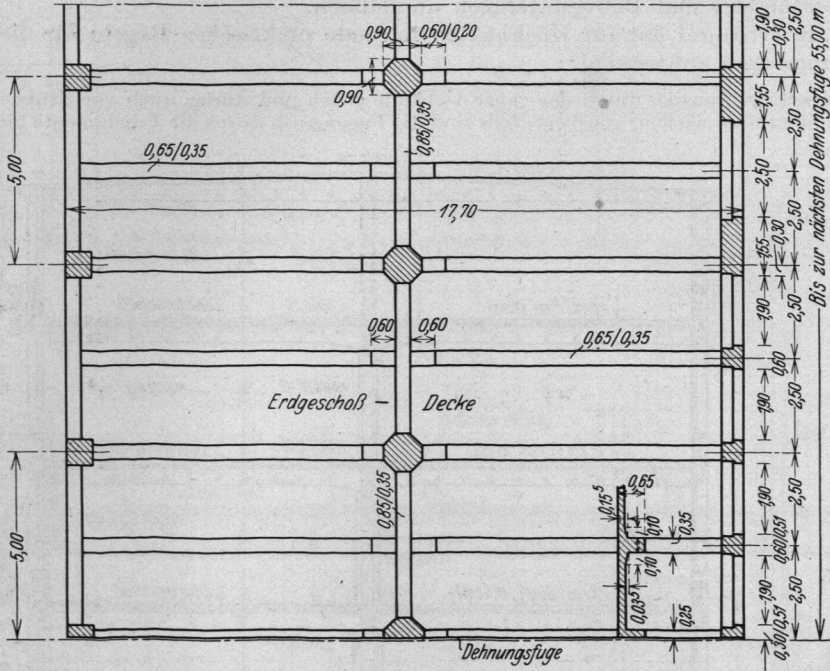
Erdgeschoßgrundriß zu Abb. 76.
